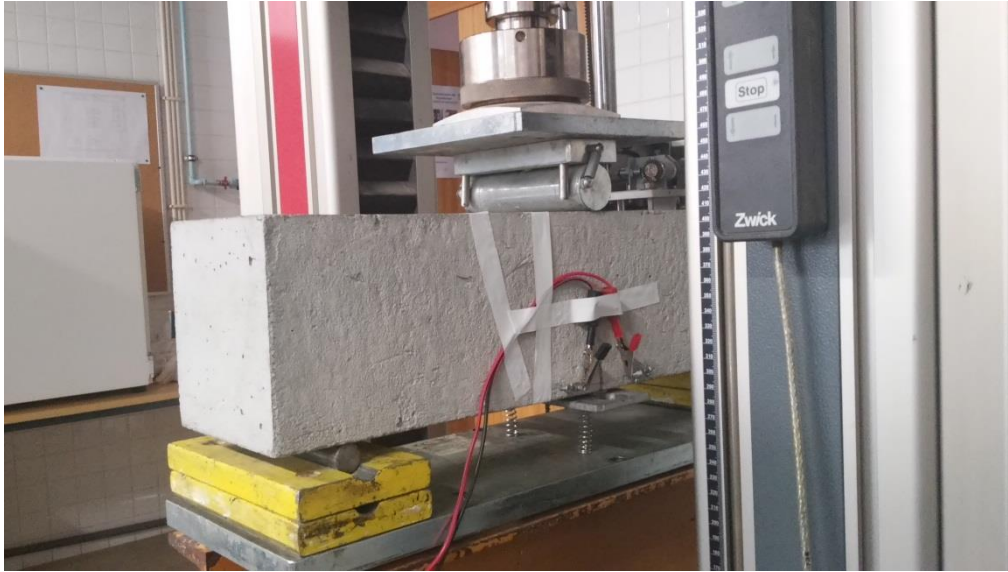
Ensaio de flexão e ligação de multímetro à LMF
